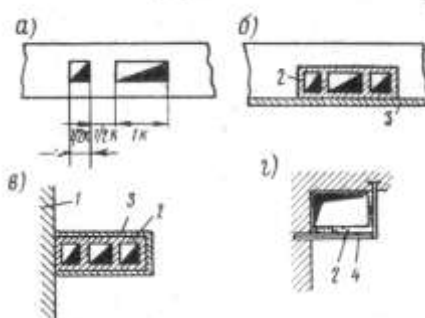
Схема решения естественной вытяжной вентиляции кухонь и санитарных узлов в кирпичном 3-х этажном здании.
